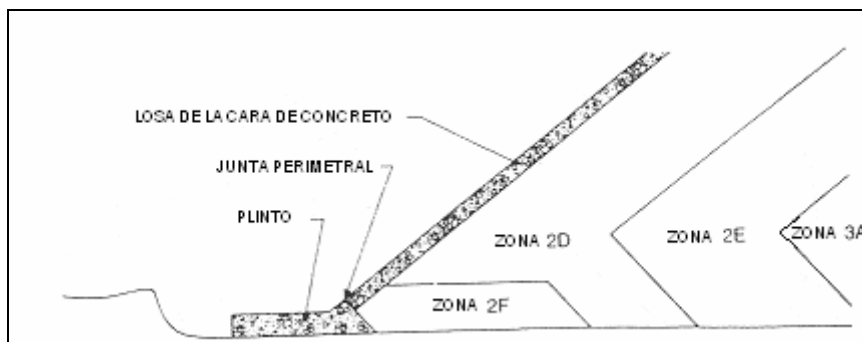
Disposición del plinto, losa de concreto y material de recargue.
